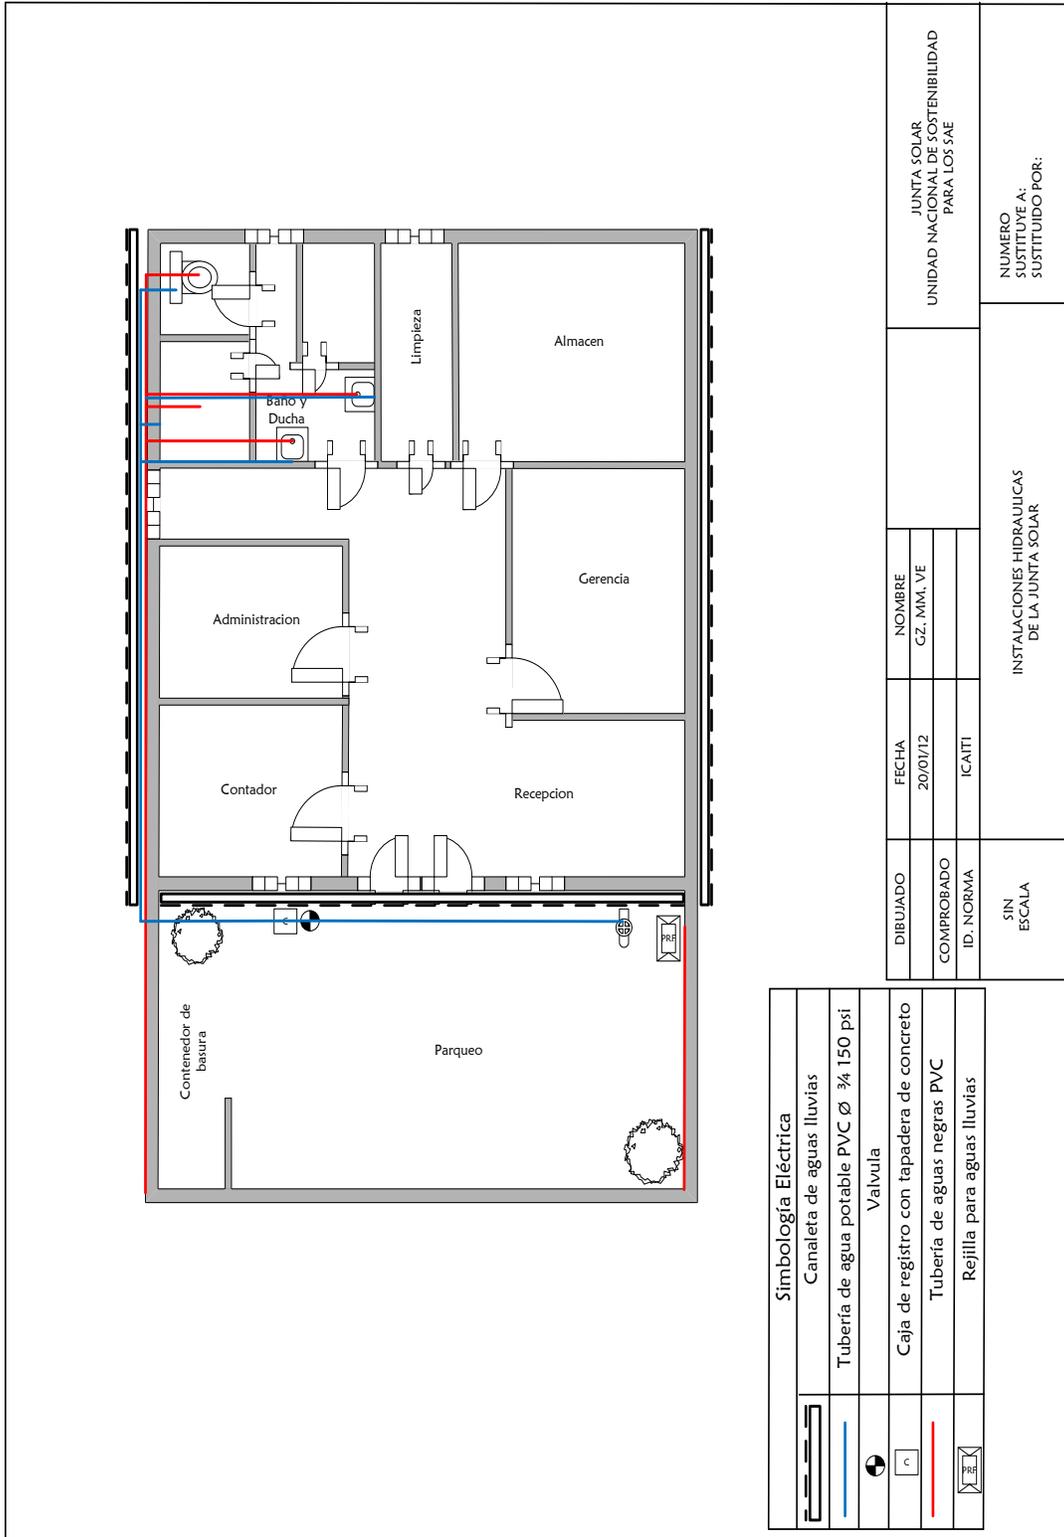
Distribucion en planta de la Junta Solar – Instalaciones Hidraulicas
